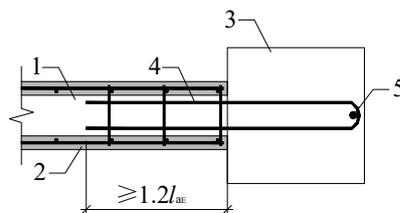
剪力墙端部钢筋搭接构造示意
